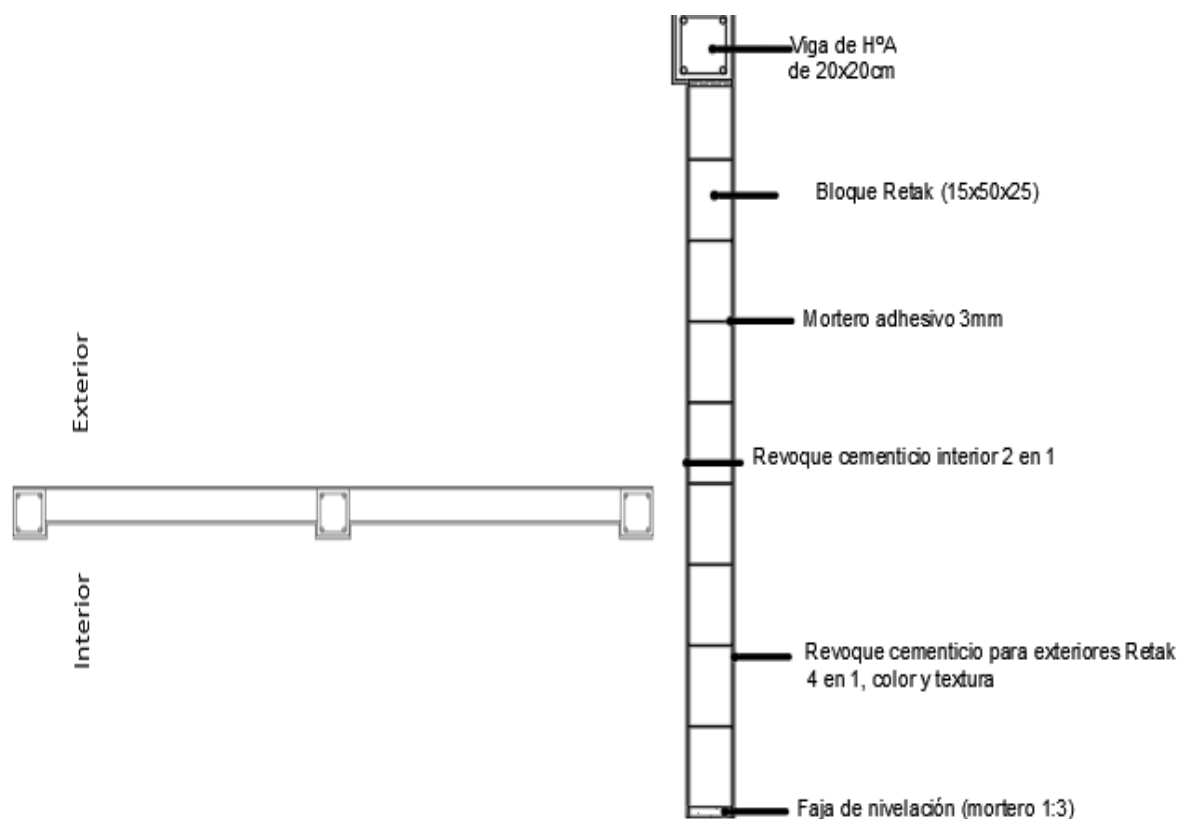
y 9 – Planta y corte vertical del muro Tipo D, de construcción mixta.
